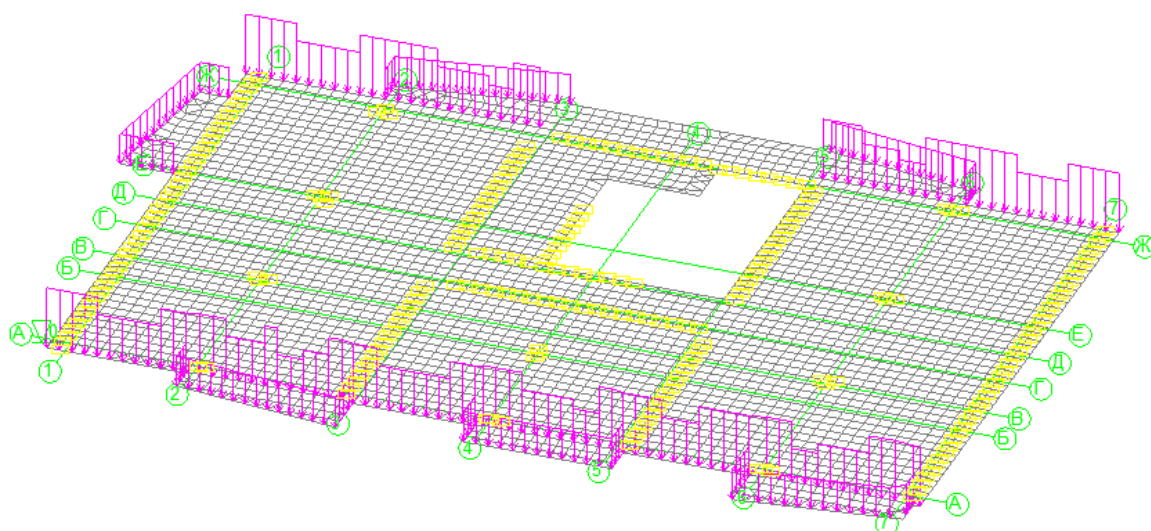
Схема приложения нагрузки от наружных ограждающих конструкций
